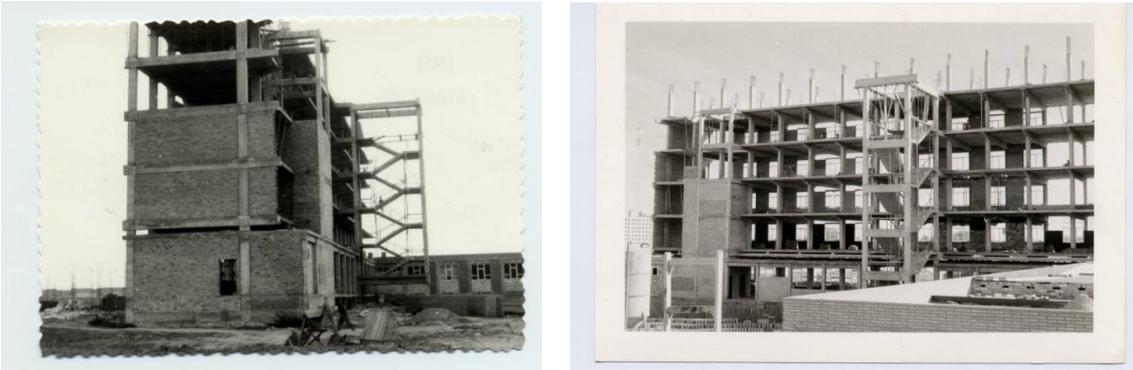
y Fig. 124. Dos fotografías de la fachada norte y noroeste en construcción. *Archivo Escuelas San José.
